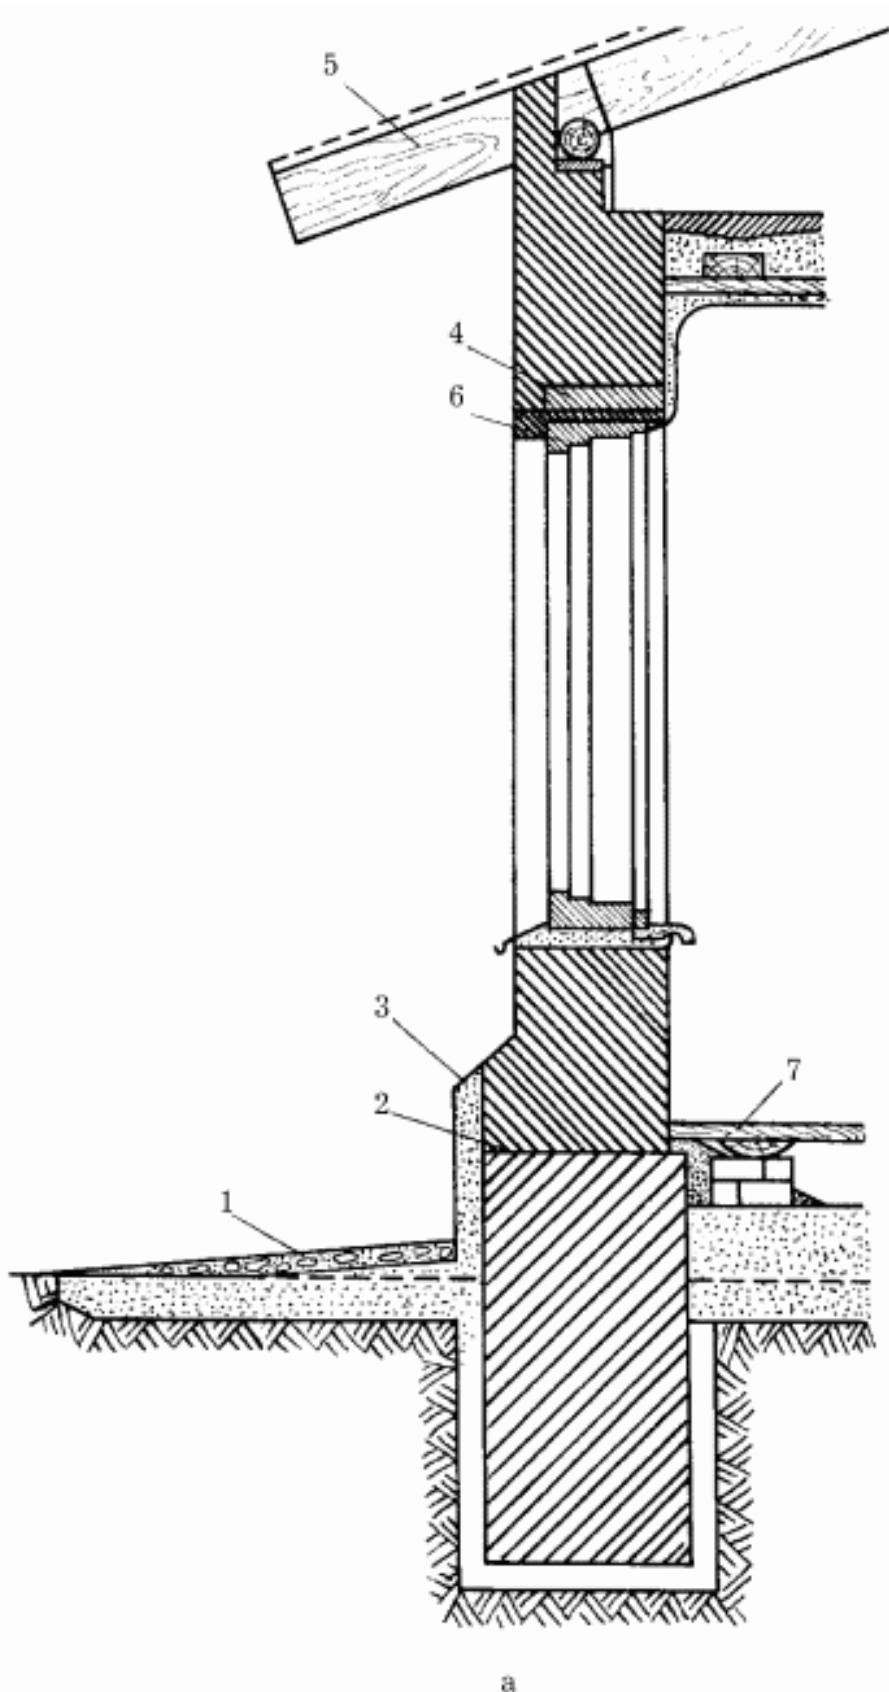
Конструктивные решения кладки сплошных стен: а – разрез стены по окну; 1 – отмостка; 2 – слой гидроизоляции; 3 – цоколь; 4 – железобетонная перемычка; 5 – карниз; 6 – оконная коробка; 7 – пол.
